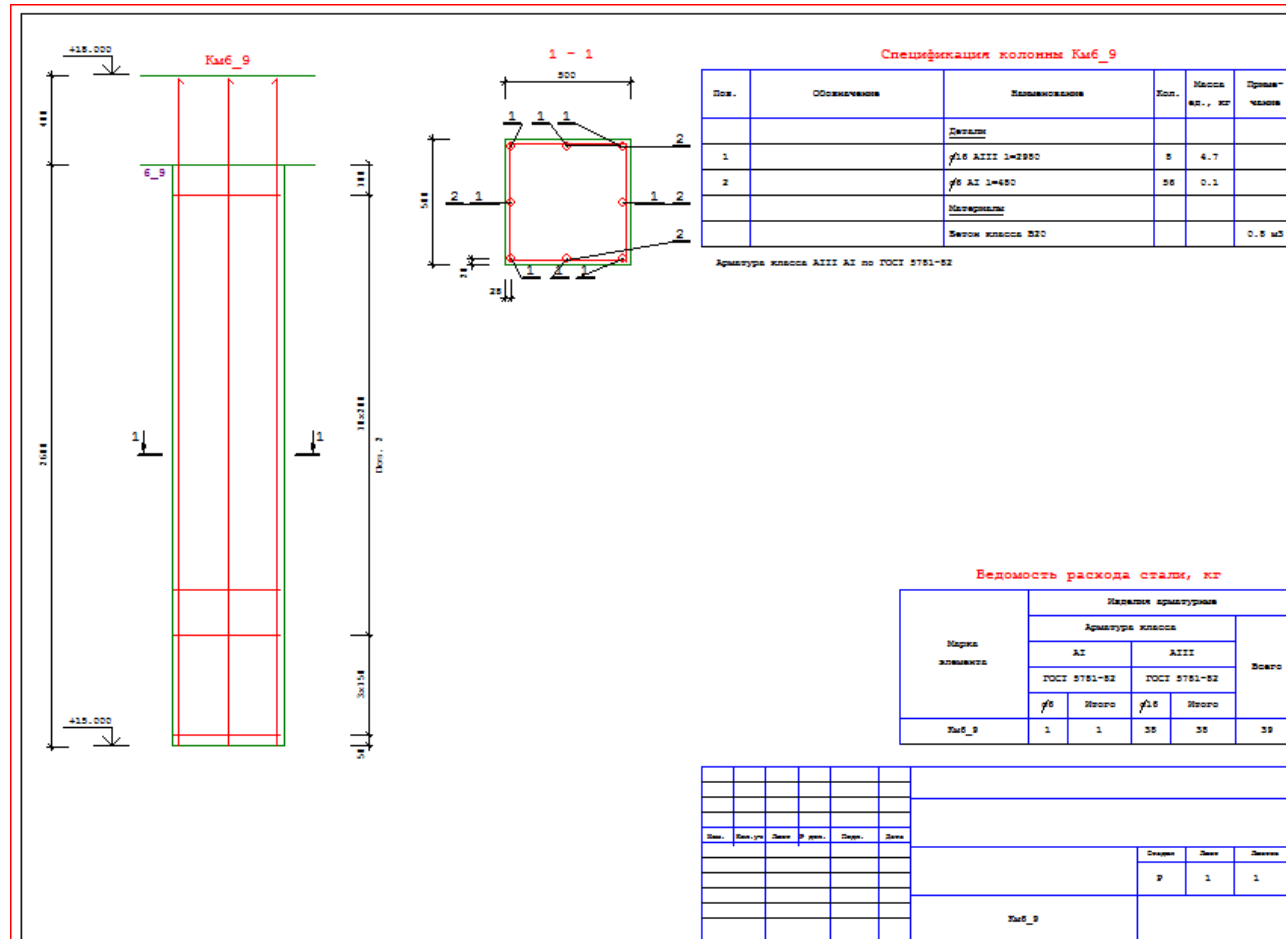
Вариант балково-плитного перекрытия. Колонна К6.9. Кресления рабочего проекта
